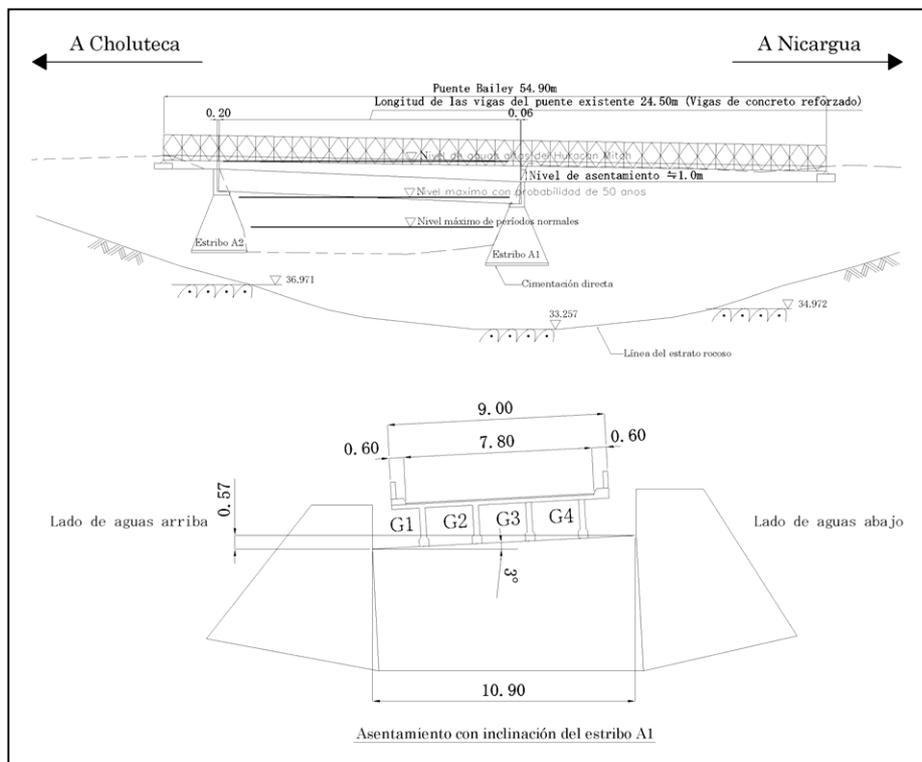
Estado de Deformación de la Estructura General del Puente Las Hormigas
